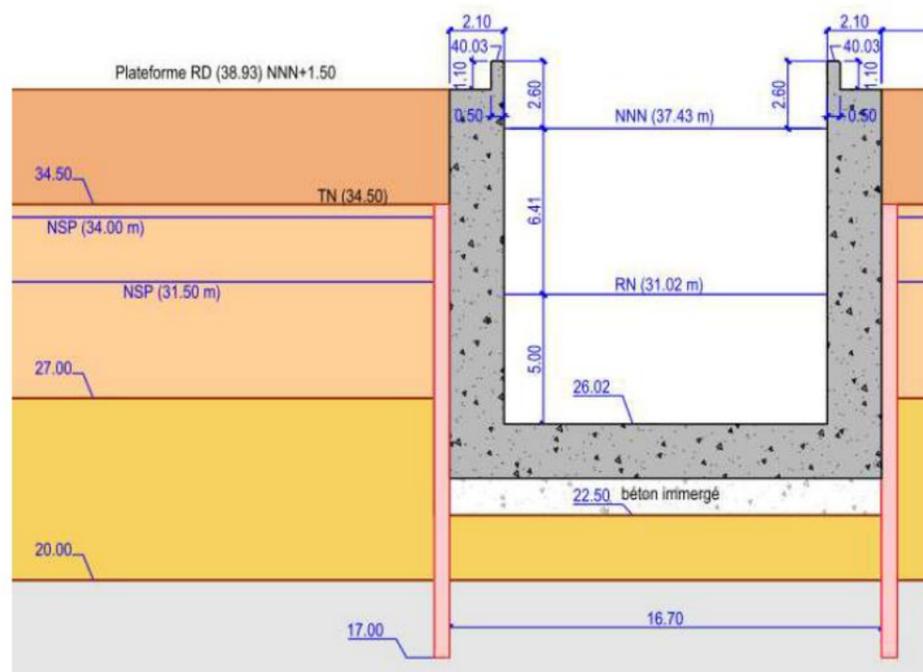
Coupe de principe du sas avec le soutènement provisoire type palplanches
